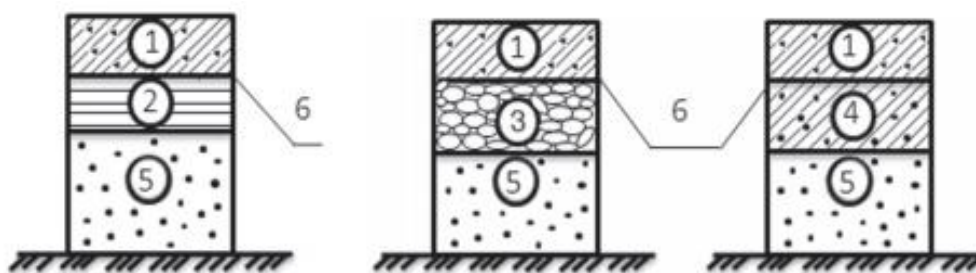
Дорожные одежды с монолитным цементобетонным покрытием
